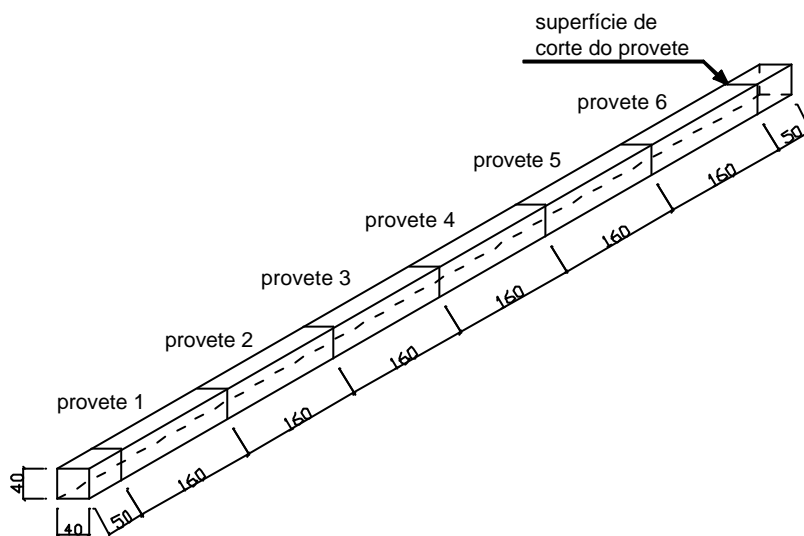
Dimensões dos corpos de prova - perspectiva.
